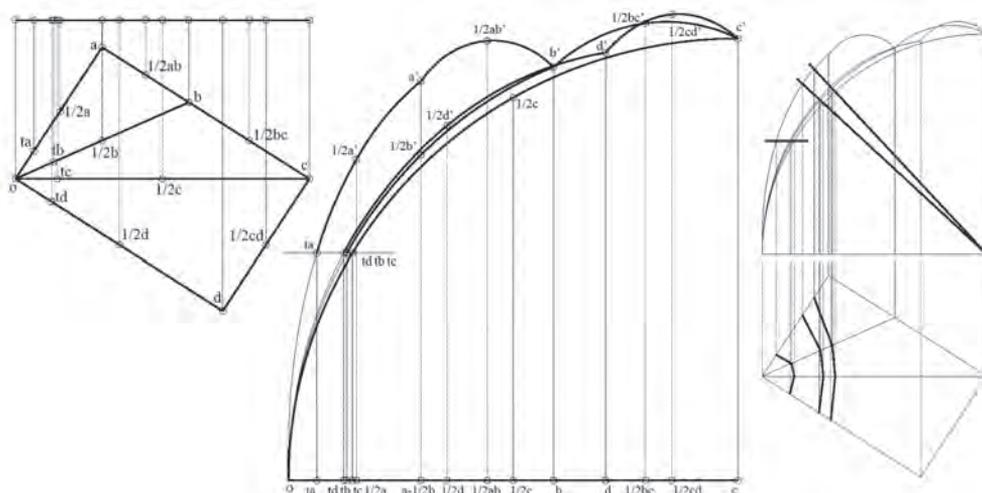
“Proyección” de las aristas (izquierda) e intersecciones con los planos de las juntas entre sillares.
